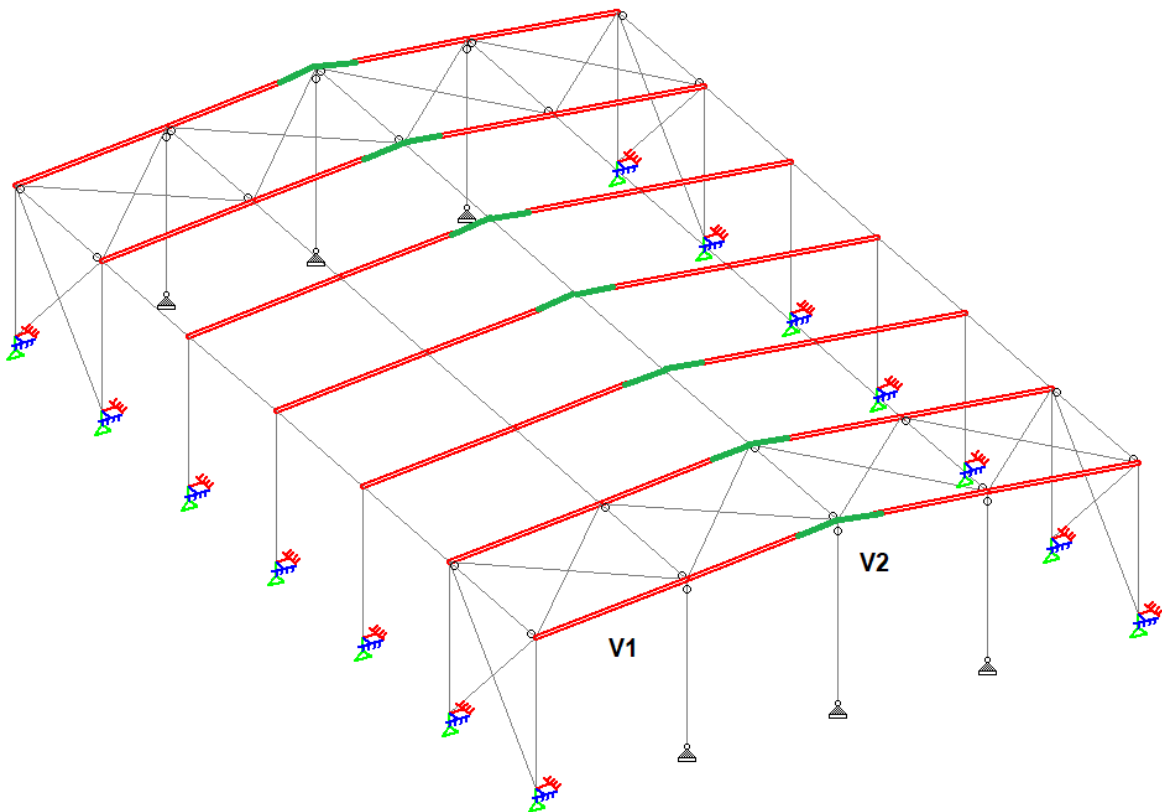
Modelo 3D de estructura resistente - Vigas. Fuente: Elaboración propia.
